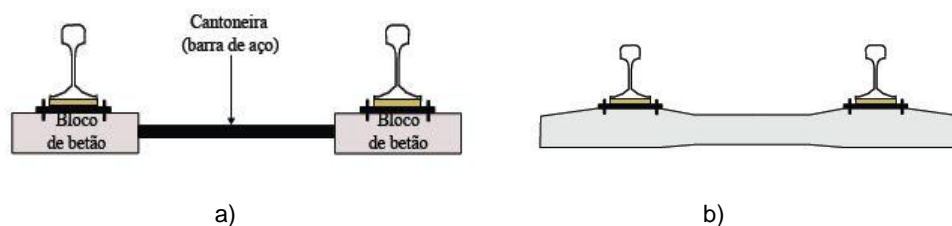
Tipos de travessas de betão: a) travessa bibloco; b) travessa monobloco (Vale, 2010)
